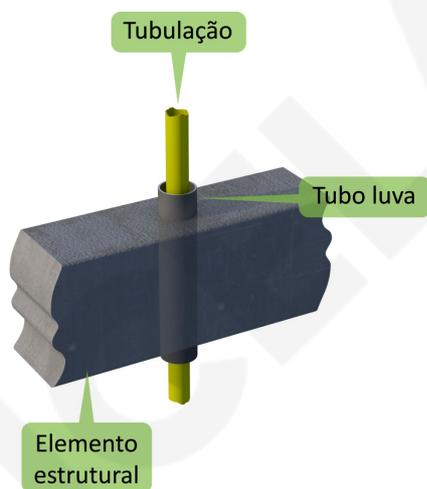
Instalação de tubo luva em elemento estrutural.
